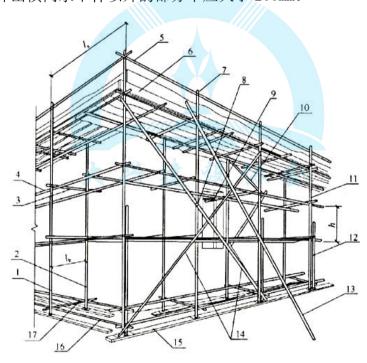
双排扣件式钢管脚手架各杆件位置示意
